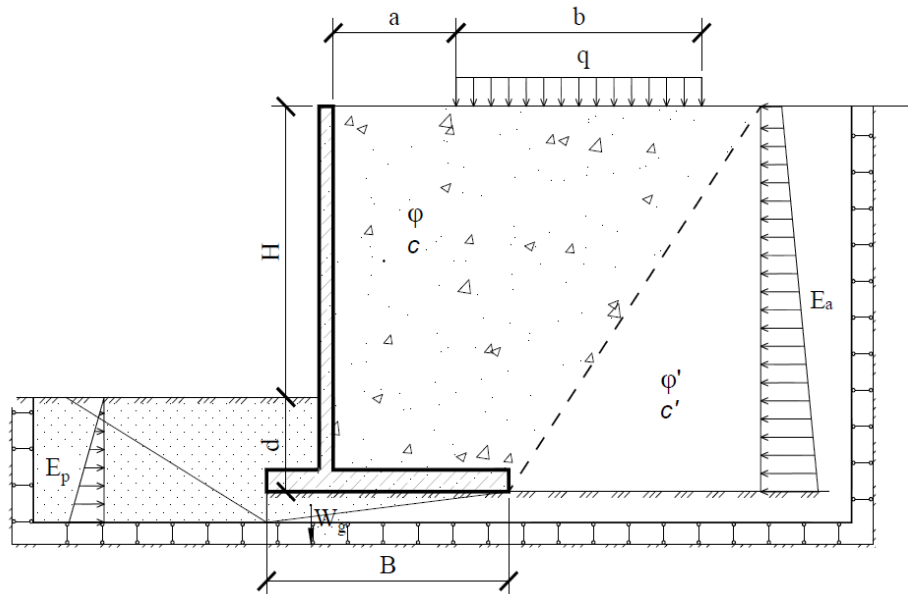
Расчетная схема уголкового подпорной стены
